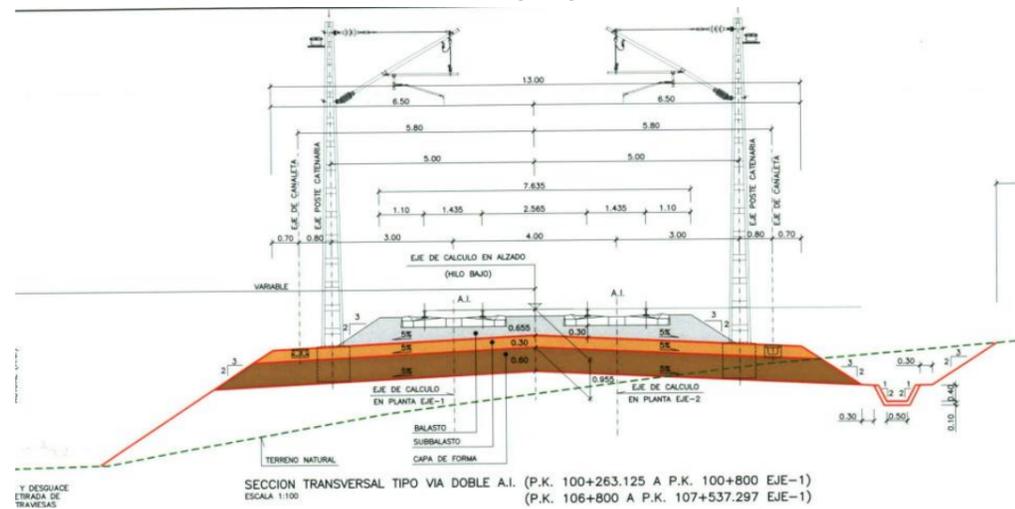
SECCIÓN TRANSVERSAL PREVISTA ENTRE ELCHE MERCANCIAS Y EMBOCADURA TÚNEL ELCHE, LADO ALICANTE
